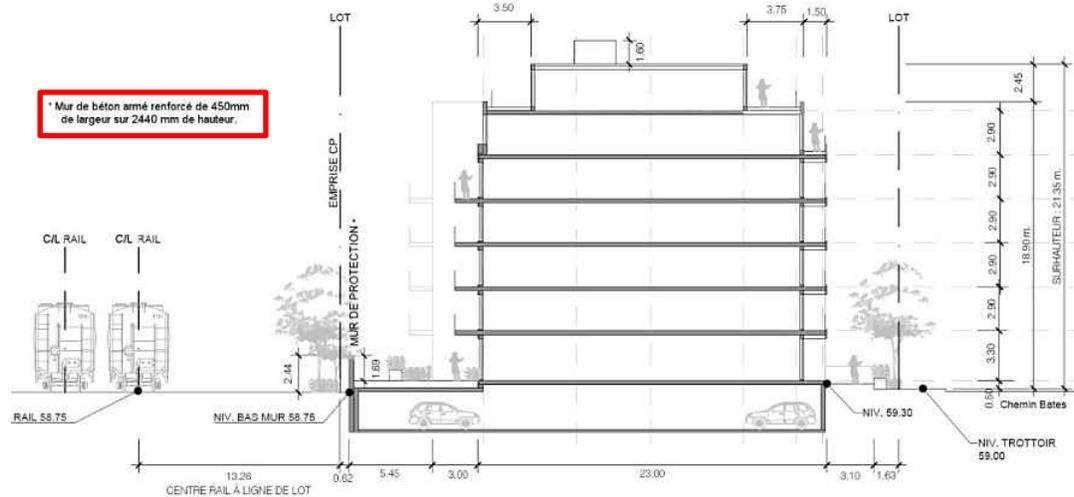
Mur structural de protection de 2,44 mètres (8'-0") minimum de hauteur en béton armé.
